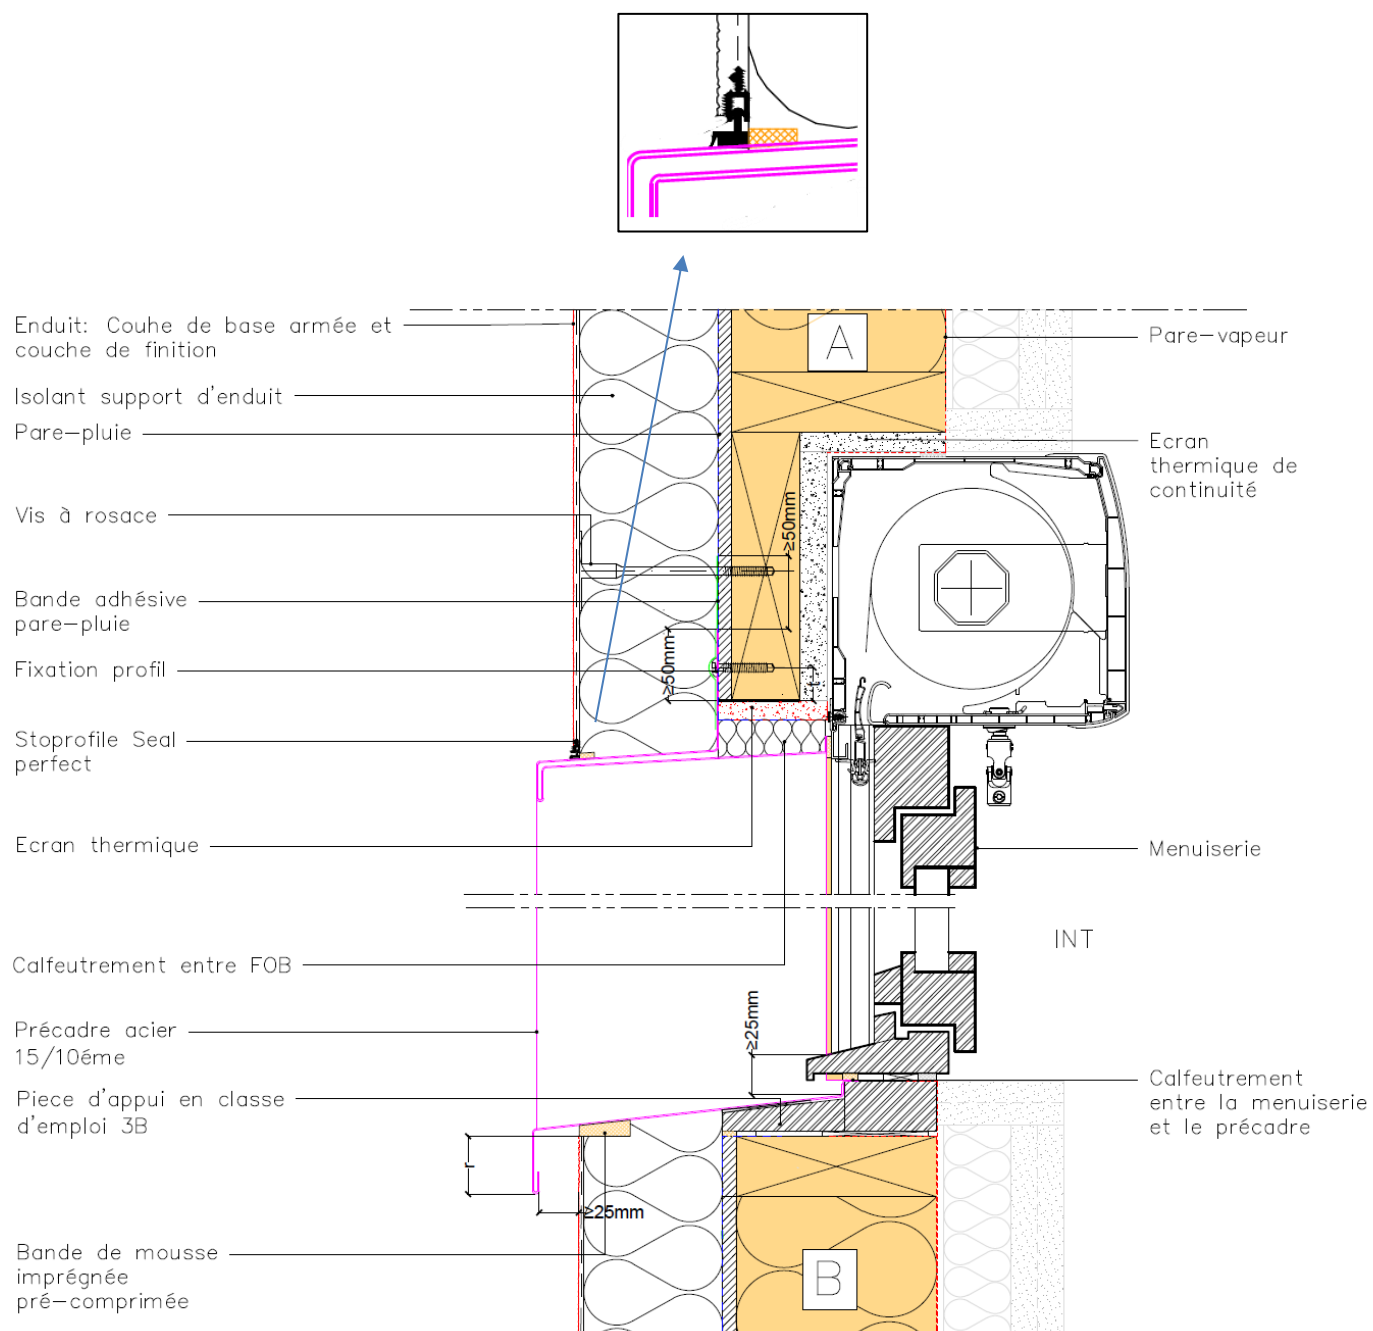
Menuiserie extérieure avec VR et précadre - Sans retour d'enduit - Coupe Verticale
